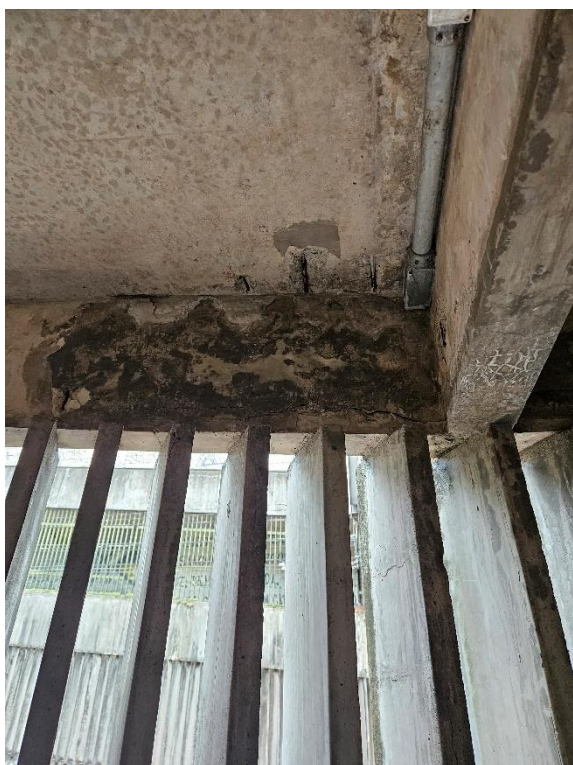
Ferragens expostas em viga e em brises de fechamento e Infiltração
